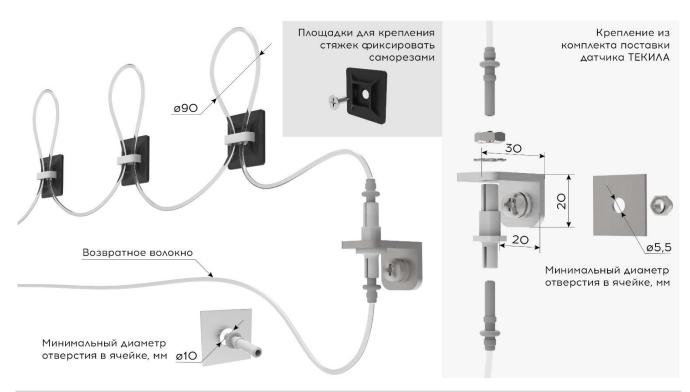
Габаритные и установочные размеры датчика ТЕКИЛА
